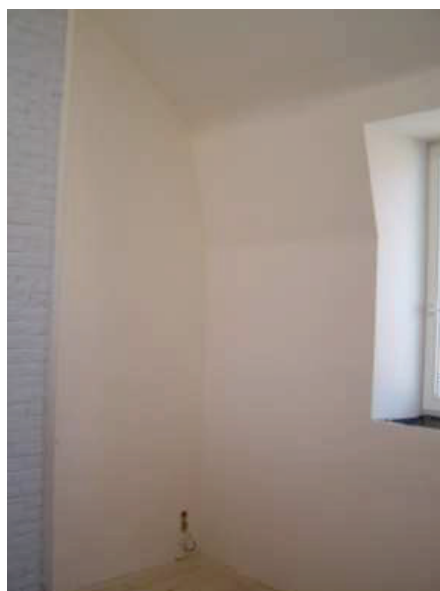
Retour d'isolant sur le mur de refend (Evrard A., 2010). (Photo : Yves Piron, architecte, Asbl Eco'Hom)
